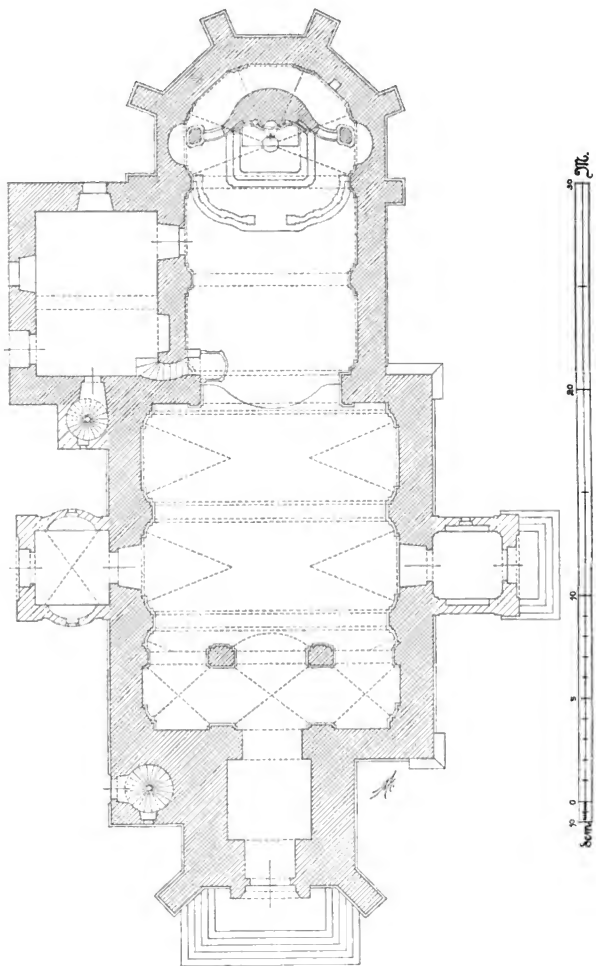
Pfibram. Dechantkirche. Grundriss.
